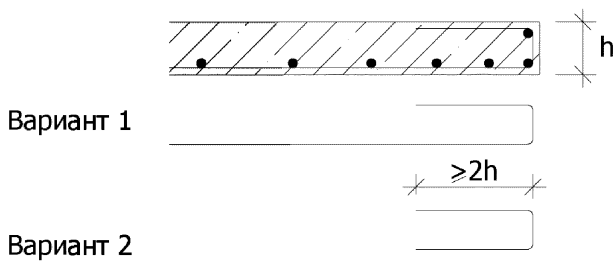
Охватывающая арматура по свободным краям плит
